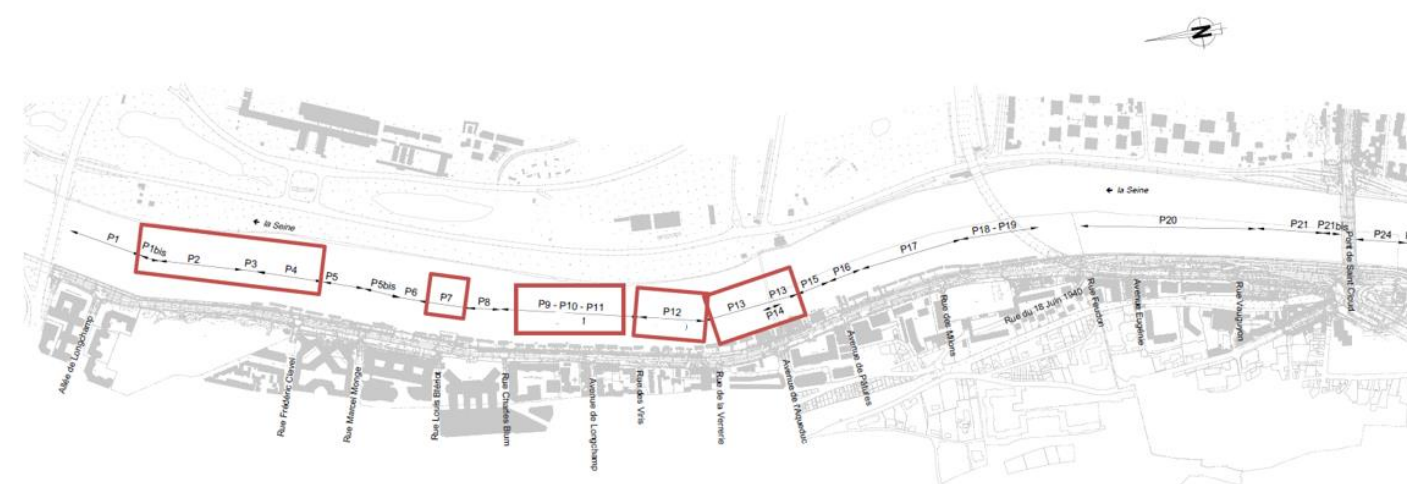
Sections de création de mur de soutènement (hors aménagement Clemenceau)
